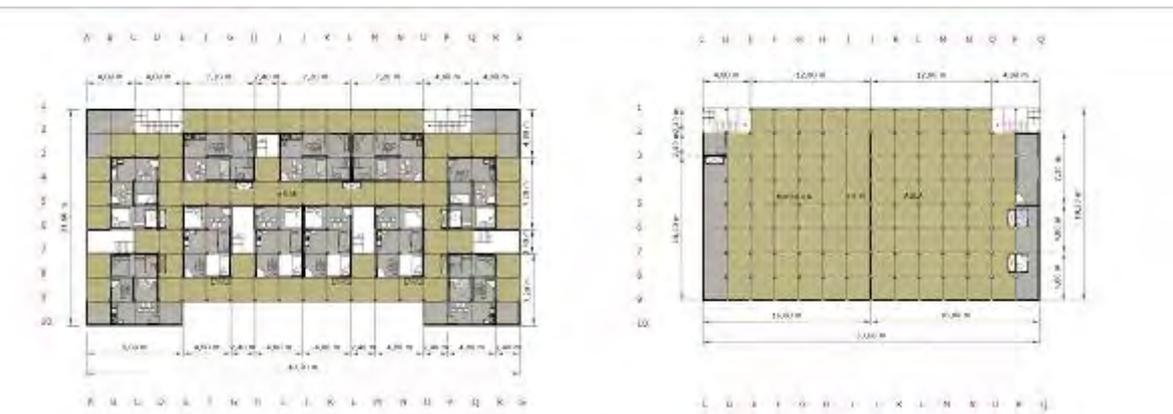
Denah Hunian Tipe Single Lt.5 & Denah Hunian Tipe Couple Lt.1
